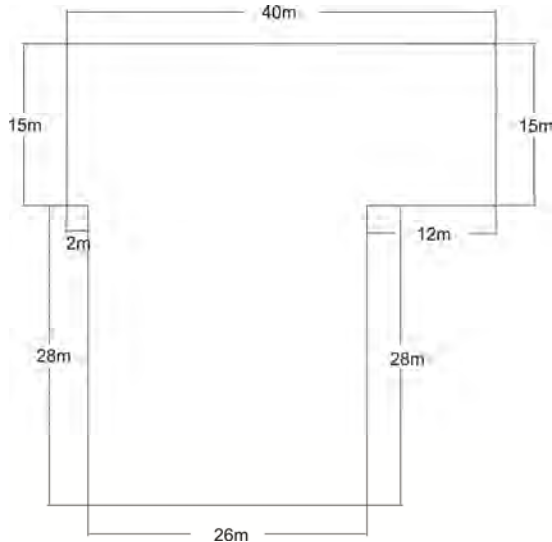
Lahan Parkir *On-street* di Jalan Dhoho
